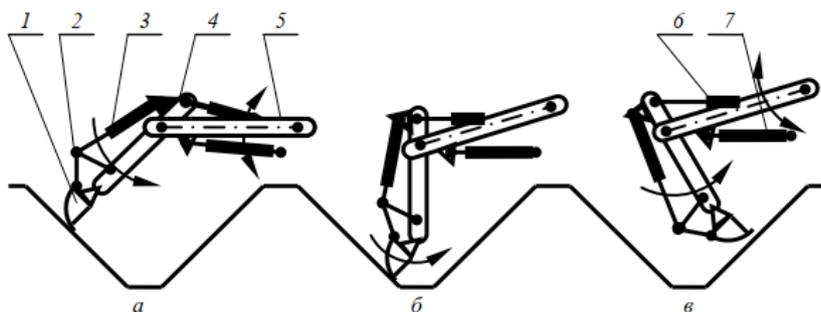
Схема работы экскаватора с уширенным поворотным (циркульным) ковшом: а — очистка дальнего откоса; б — очистка дна; в — очистка ближнего откоса; 1 — ковш; 2 — рычажная система; 3 — гидроцилиндр рукояти; 4 — рукоять; 5 — стрела; 6 — фреза; 7 — гидроцилиндр стрелы
